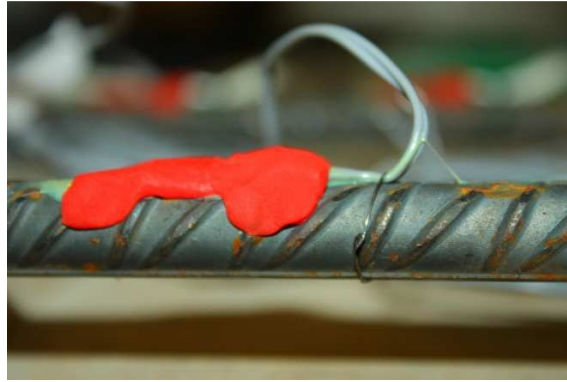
Aplicação de camada viscosa de protecção do extensómetro
